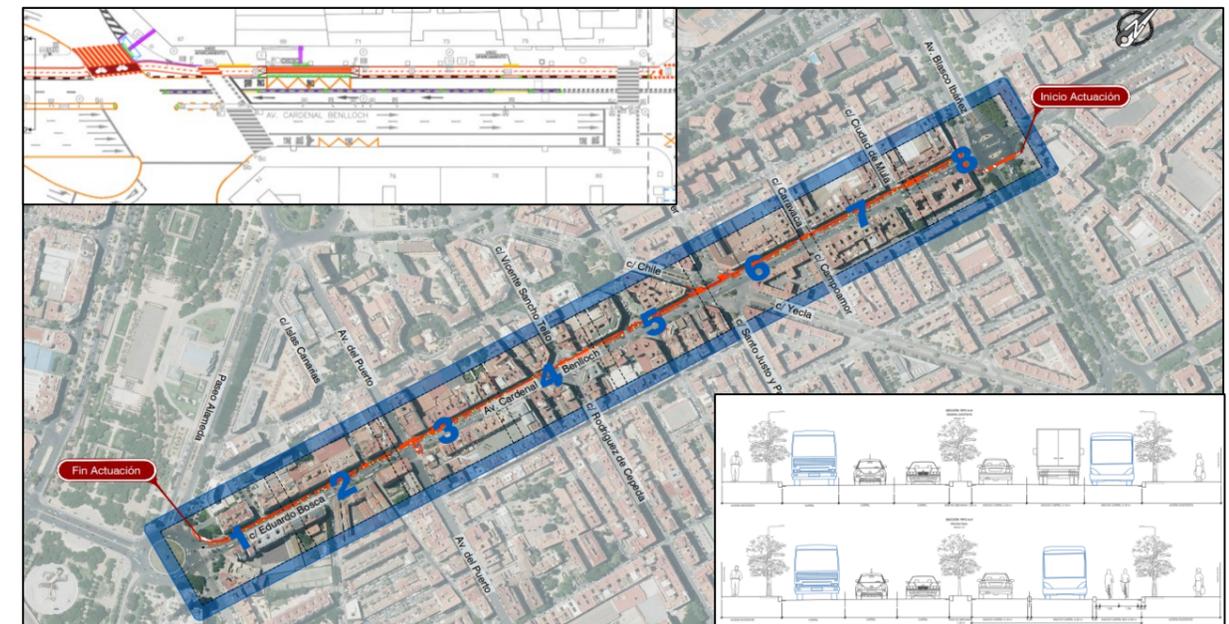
Planos del proyecto de ejecución de carril bici en la calle Cardenal Benlloch con plano de situación (central), plano de detalle de planta (superior izquierda) y sección tipo (inferior derecha). Fuente: Proyecto de construcción de carril bici en las avenidas Cardenal Benlloch y Eduardo Boscà (València), 2020.
